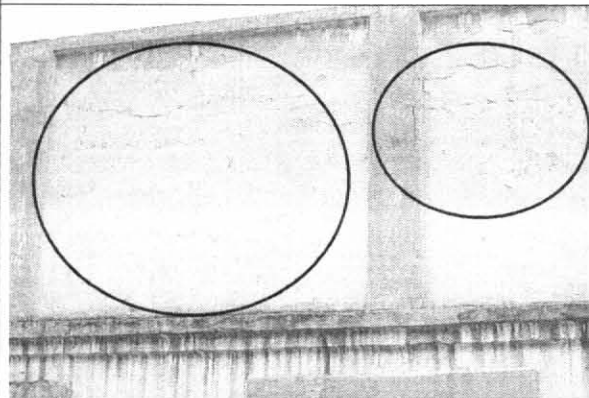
Agrietamiento leve del muro en la fachada del inmueble.
